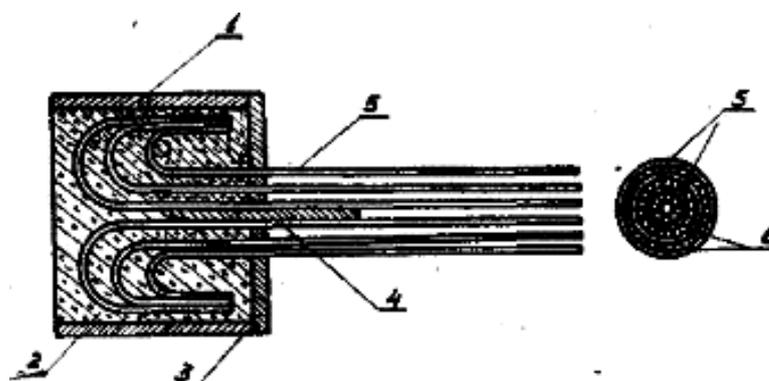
Конструкция арматурного пучка ЦНИИС МТС: 1 - анкерный стакан; 2 - бетон М 500-600; 3 - сварной шов; 4 - конический сердечник из мягкой стали; 5 - высокопрочная проволока; 6 - вязальная проволока.
